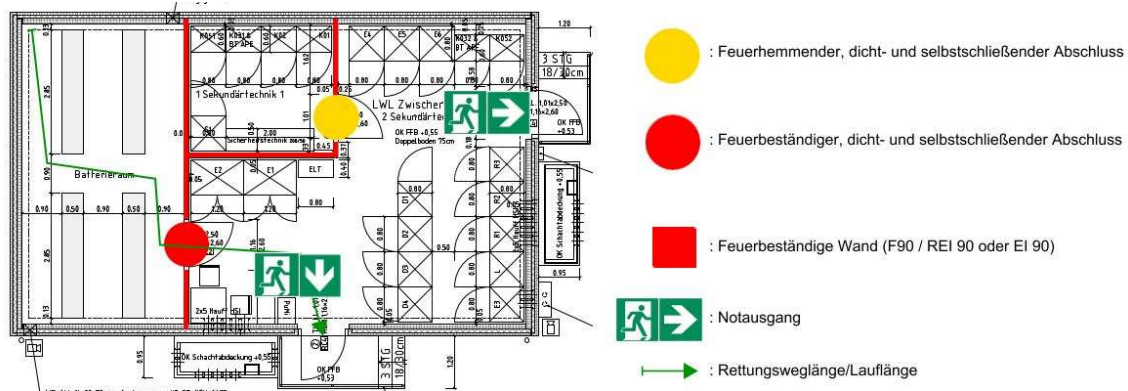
Brandschutzplan LWL-ZS5A1 - Grundriss
